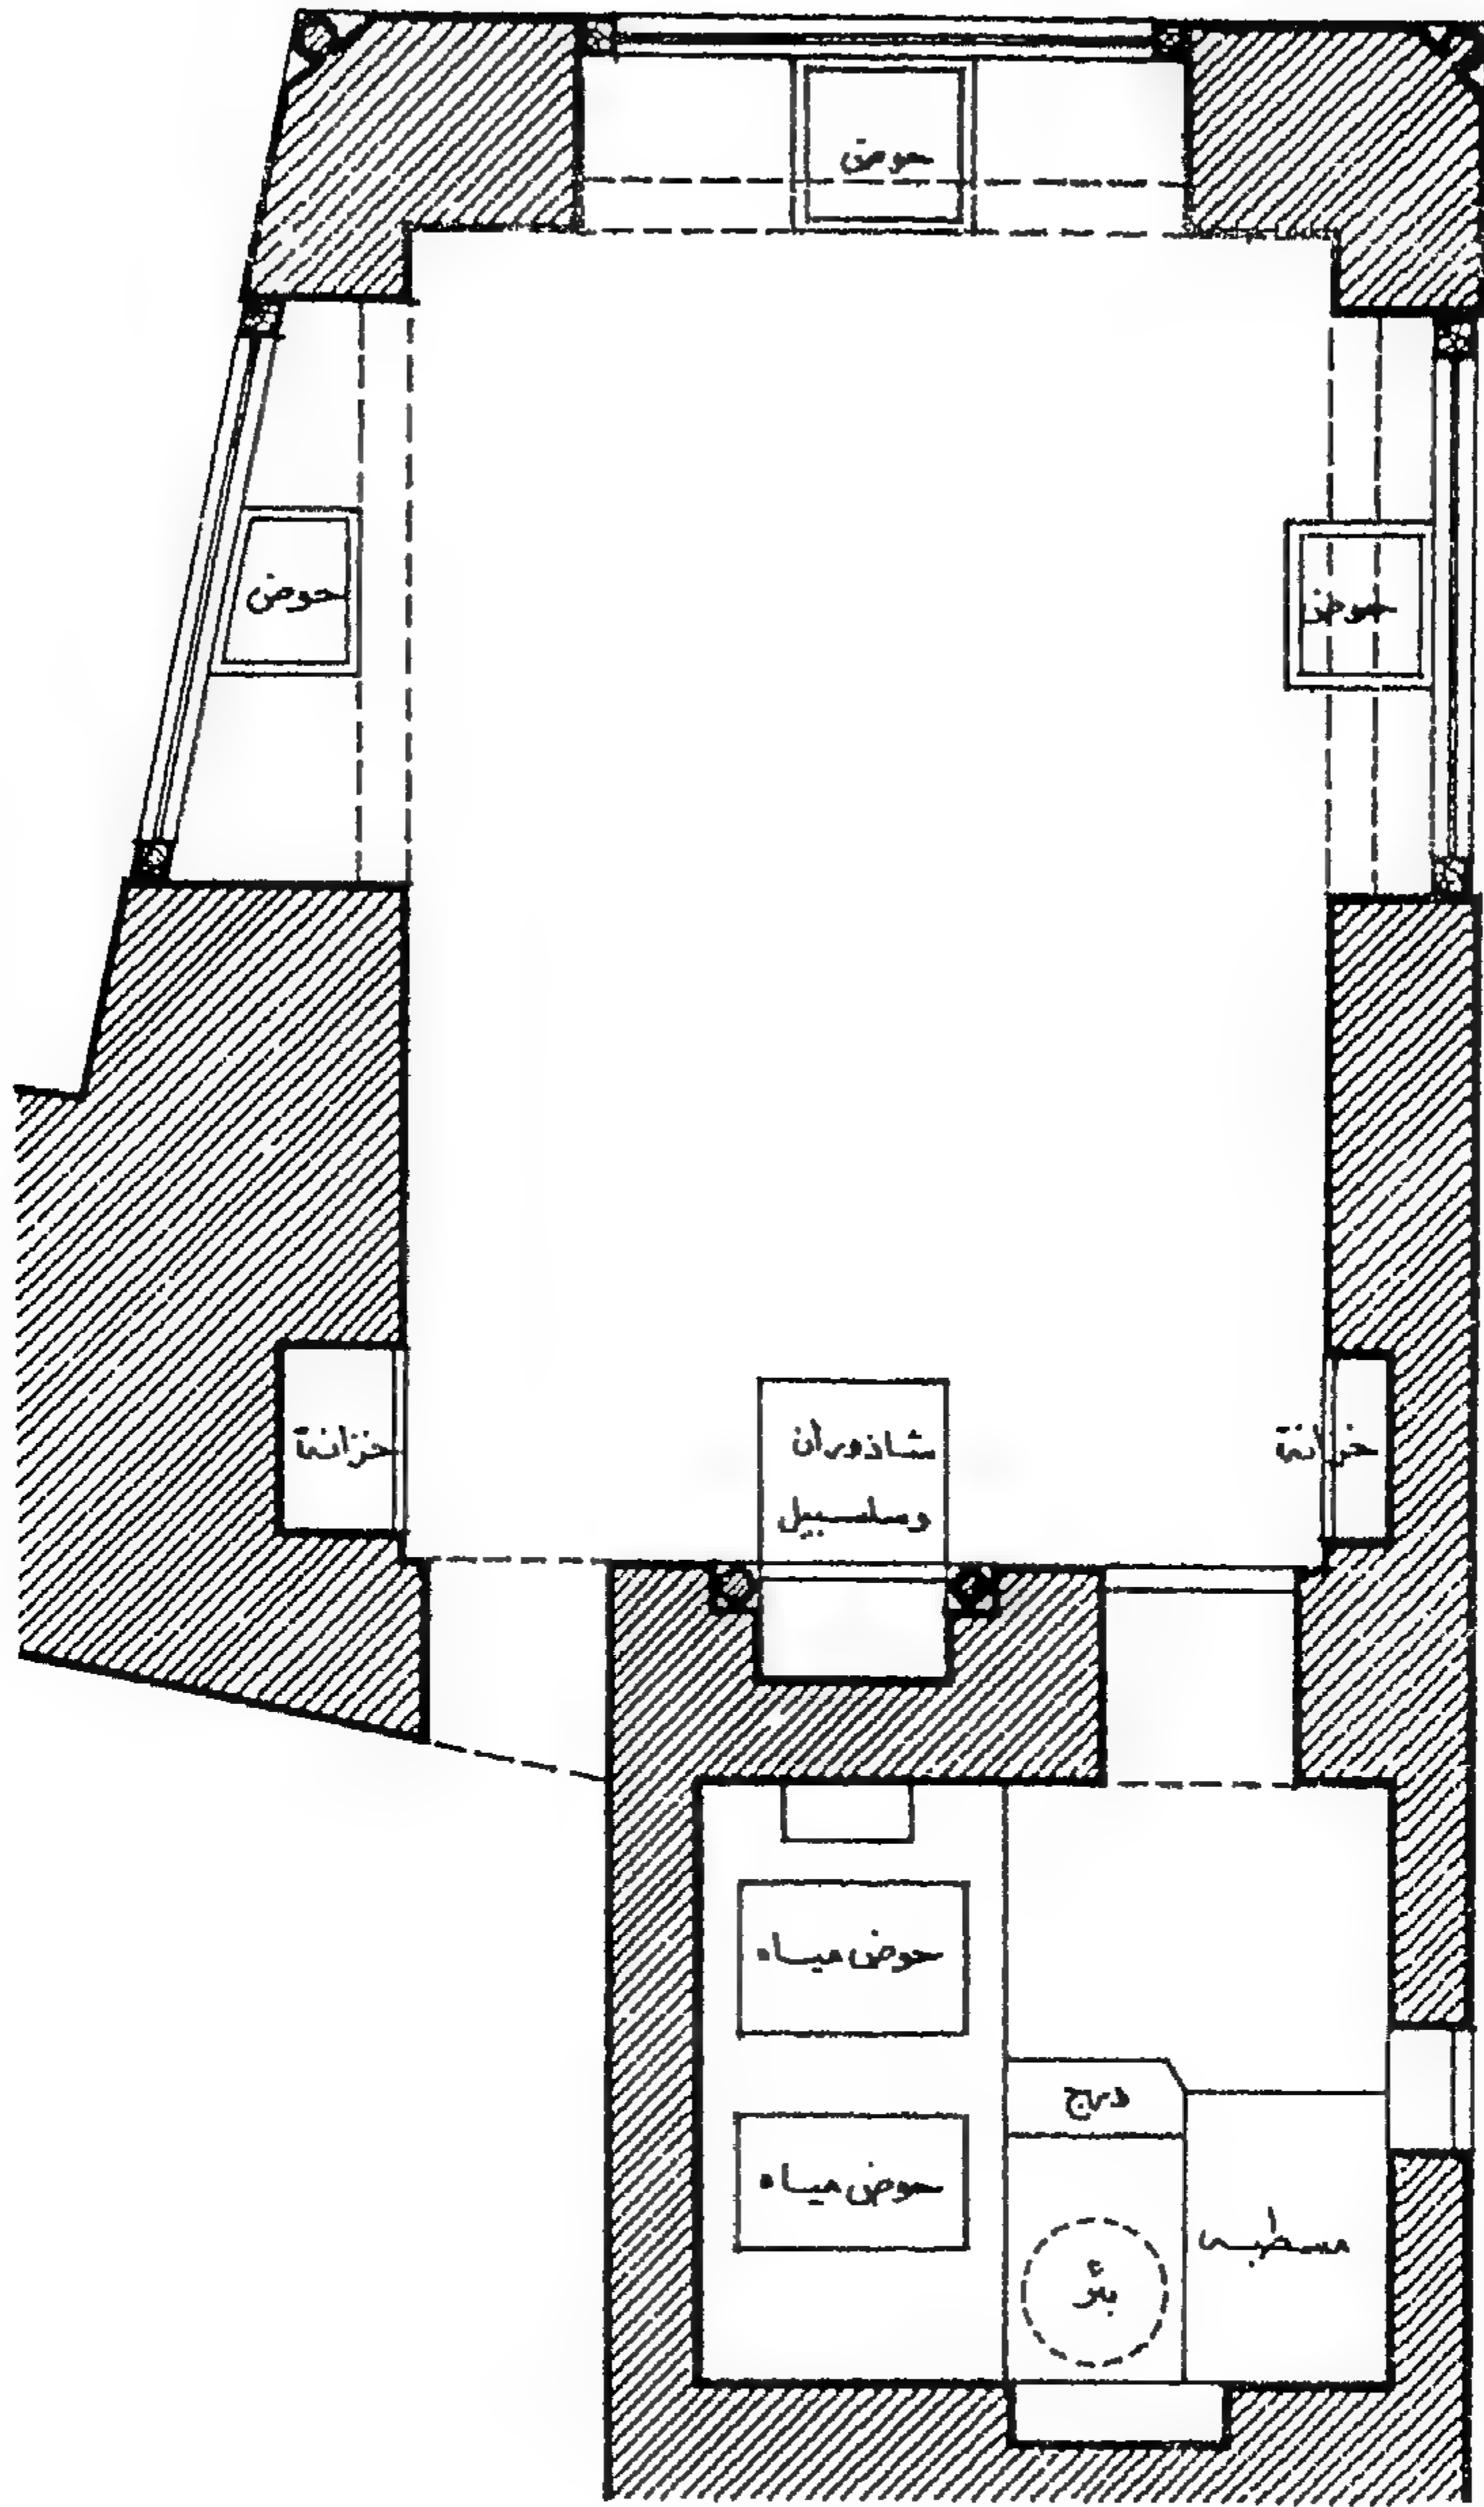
مكرر) مسقط أفقي لقبة
